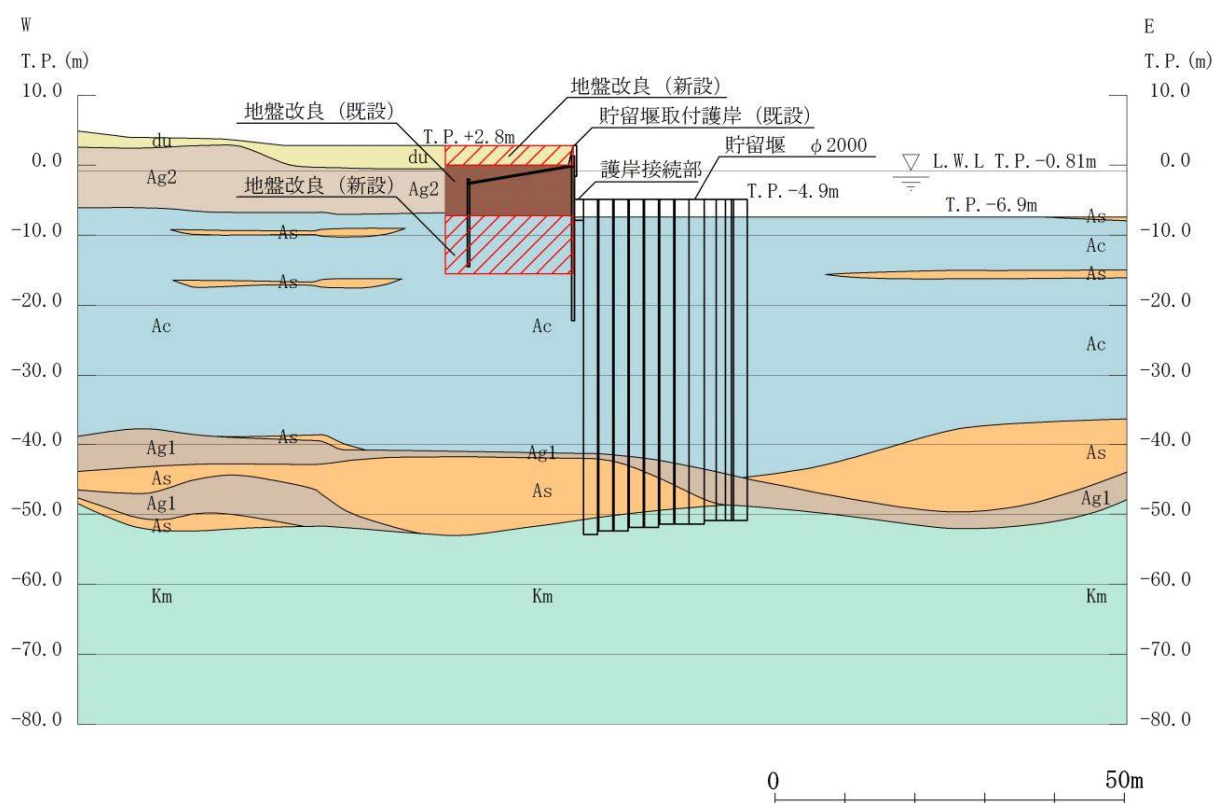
貯留堰取付護岸の断面図 (A-A 断面)
